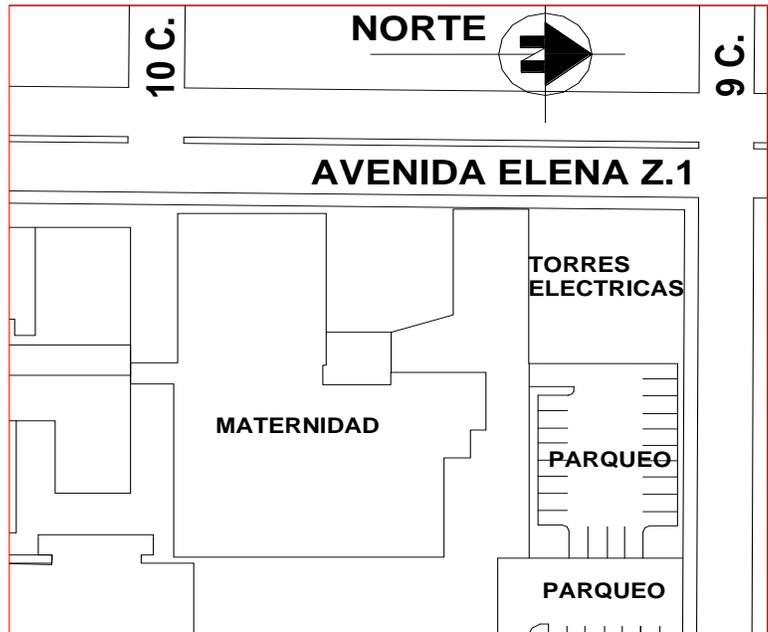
Fuente HGSJD Planta de Localización del Terreno Propuesto
